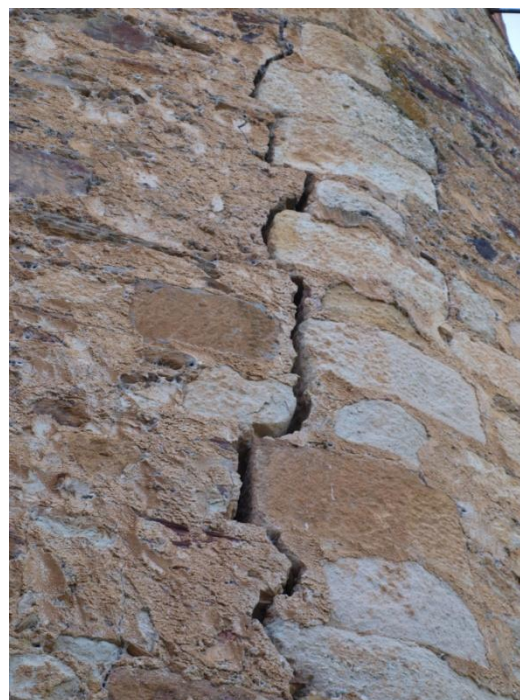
Imagen de la grieta descrita anteriormente.
